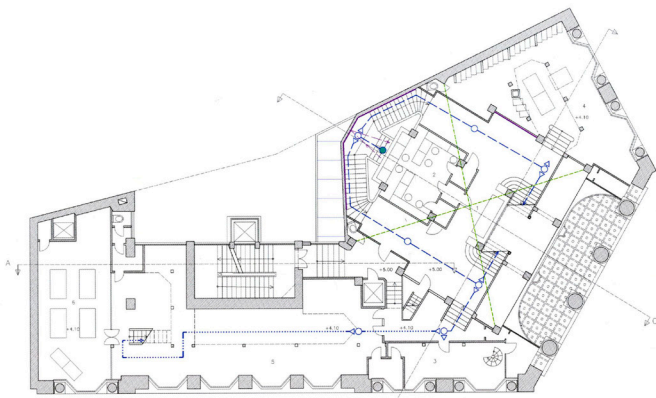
Edificio *Sulla Michaelerplatz*. Plano de la planta primera.
